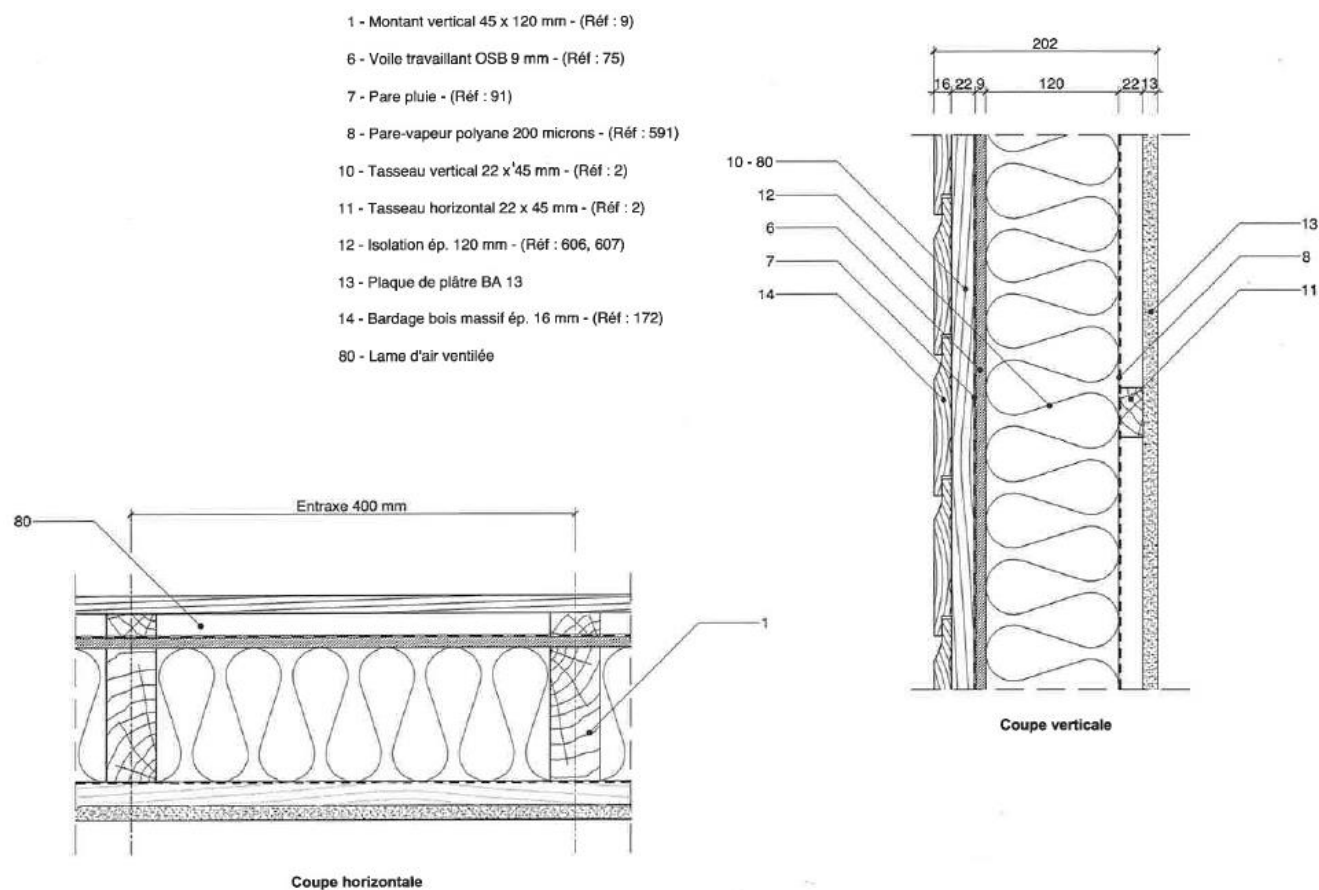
Maisons Bois Outils Concept – Construire Tome 2 © CNDB
